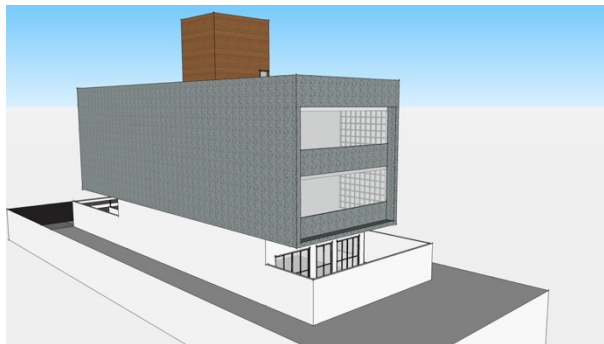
Fachadas com aplicação do Revestimento em Granito
